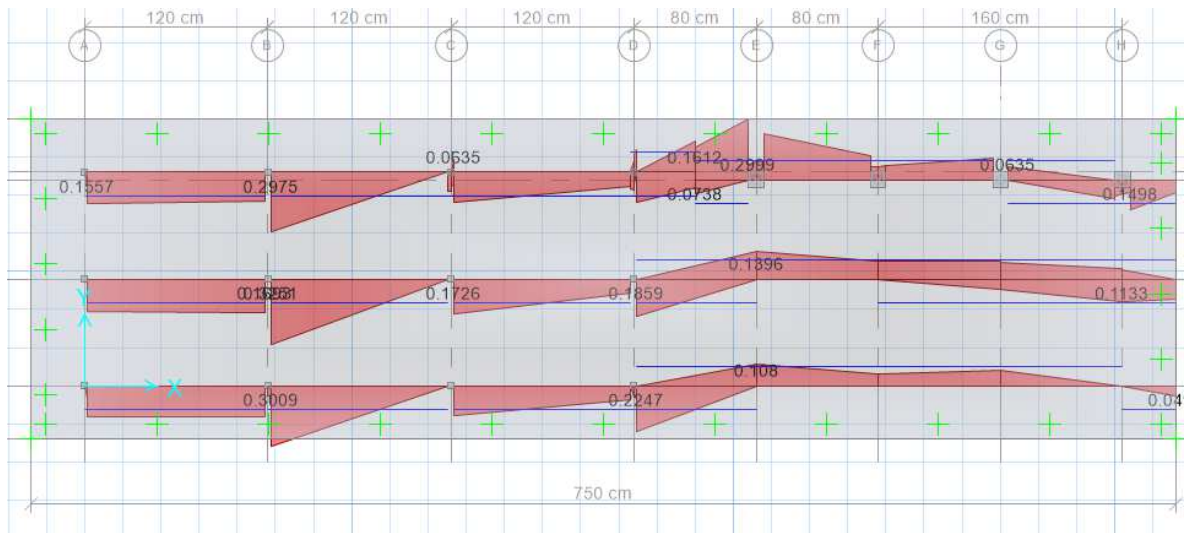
Área de refuerzo en dirección x (losa de sistema de alimentación)
